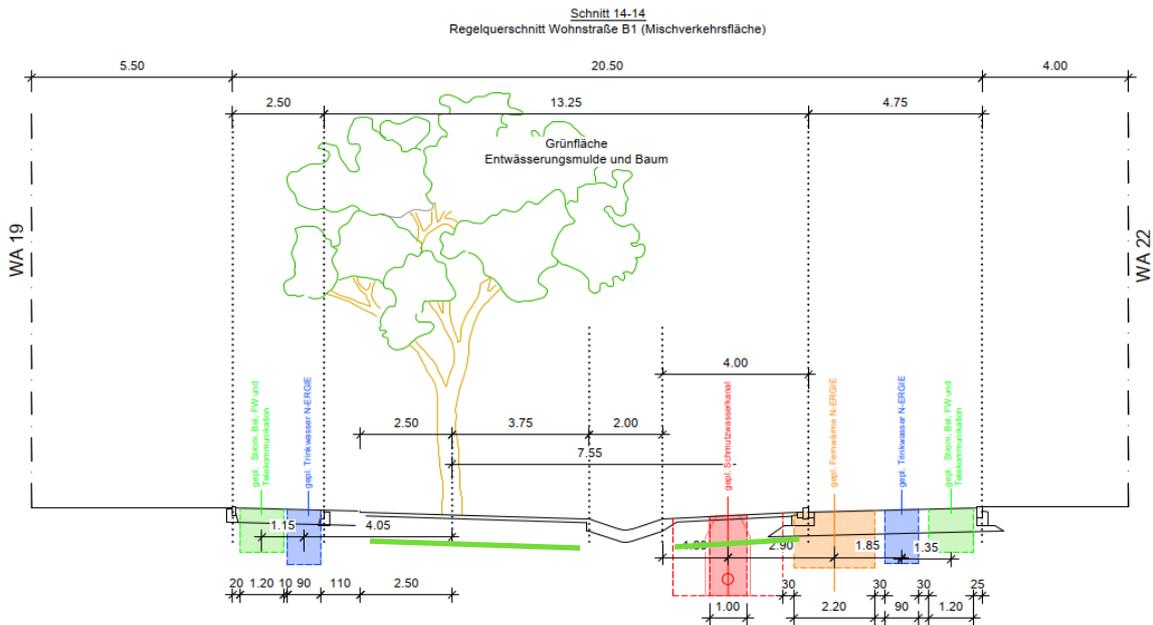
Querschnitt Wohnstraße B, (LP 2; Stand: 30.05.2025); Quelle: Gauff Engineering
